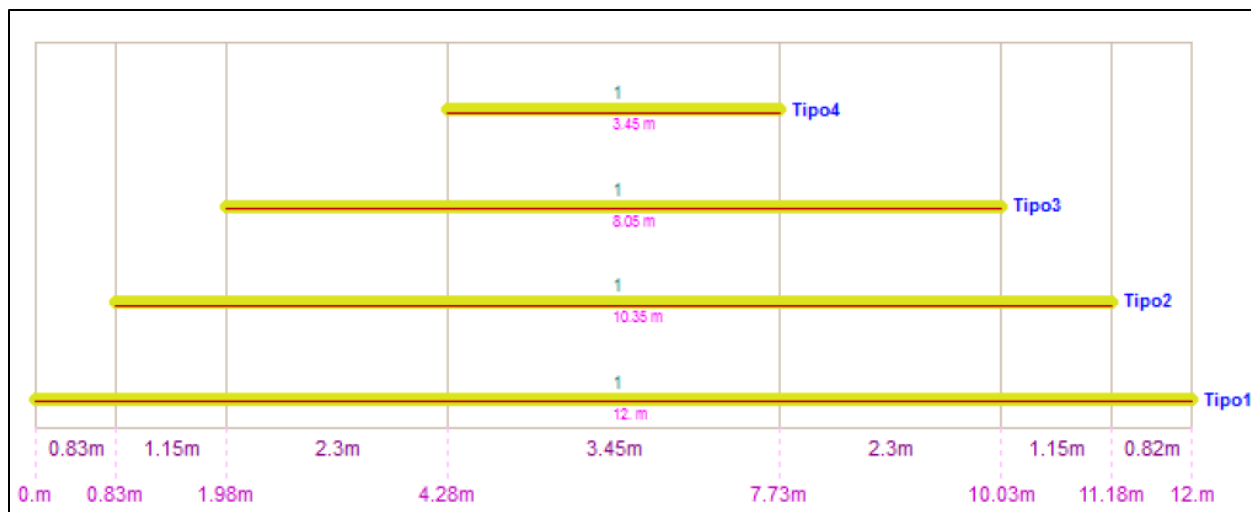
Detalle de las longitudes de las varillas comunes por tipos.
